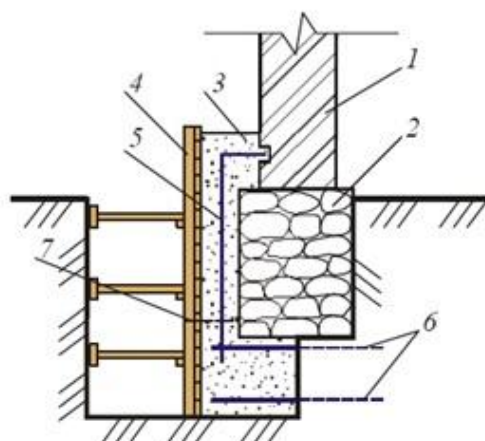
Уширение подошвы фундамента банкетами [2]
